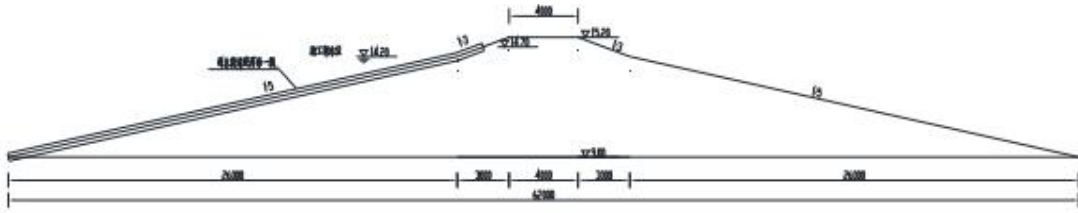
1#拦河围堰断面图 (单位: mm)
